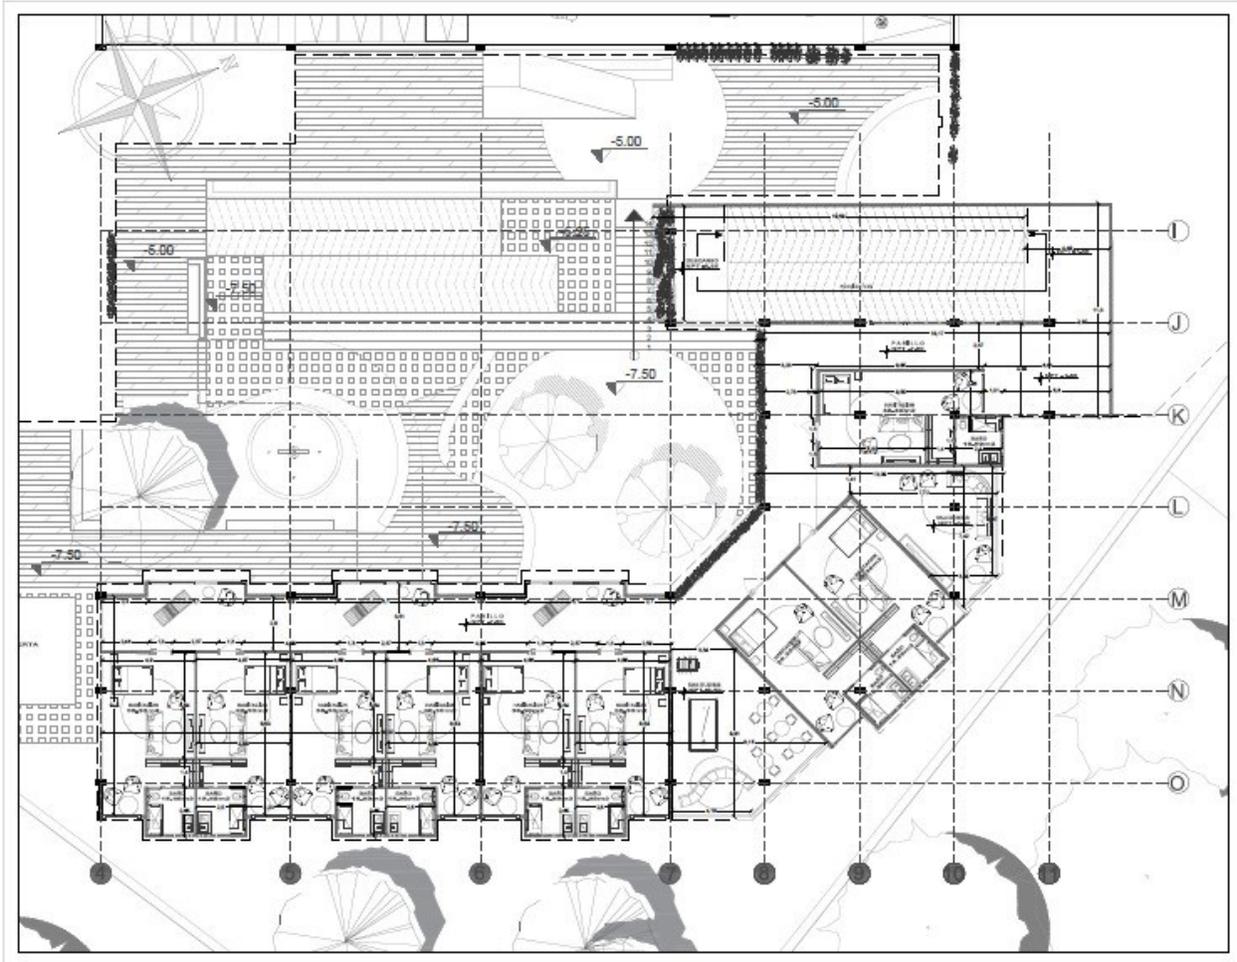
Planta -2 Edificación 3 (Rubiano, 2020)
